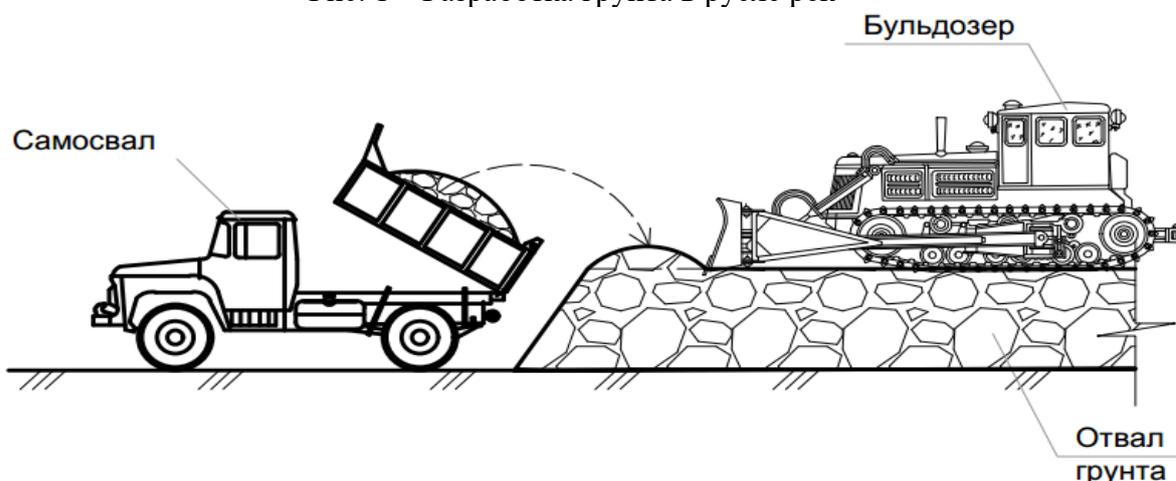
Разработка грунта в отвал и планировка отвала на специальной площадке
